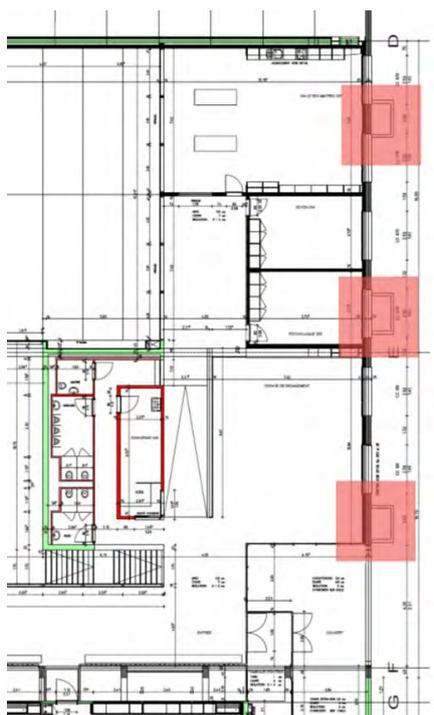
localisation sur plan (en rouge) des sauts-de-loup du bâtiment
